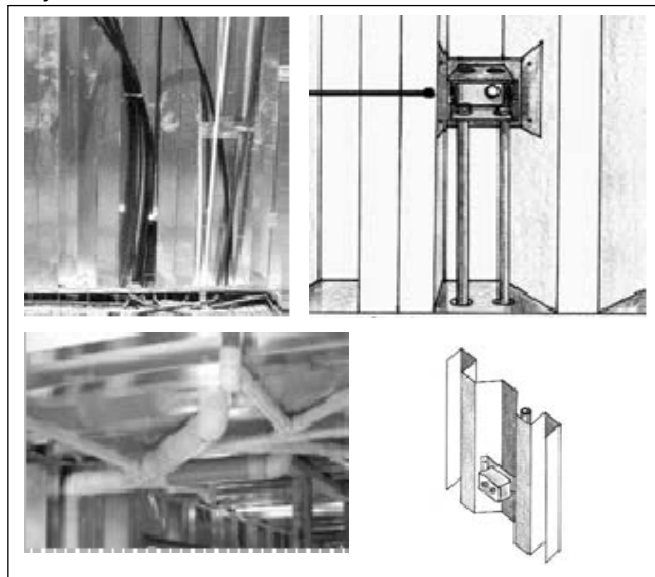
Colocación de las tuberías de servicio. Fuente: Manual de SIPROMAT. 2005
